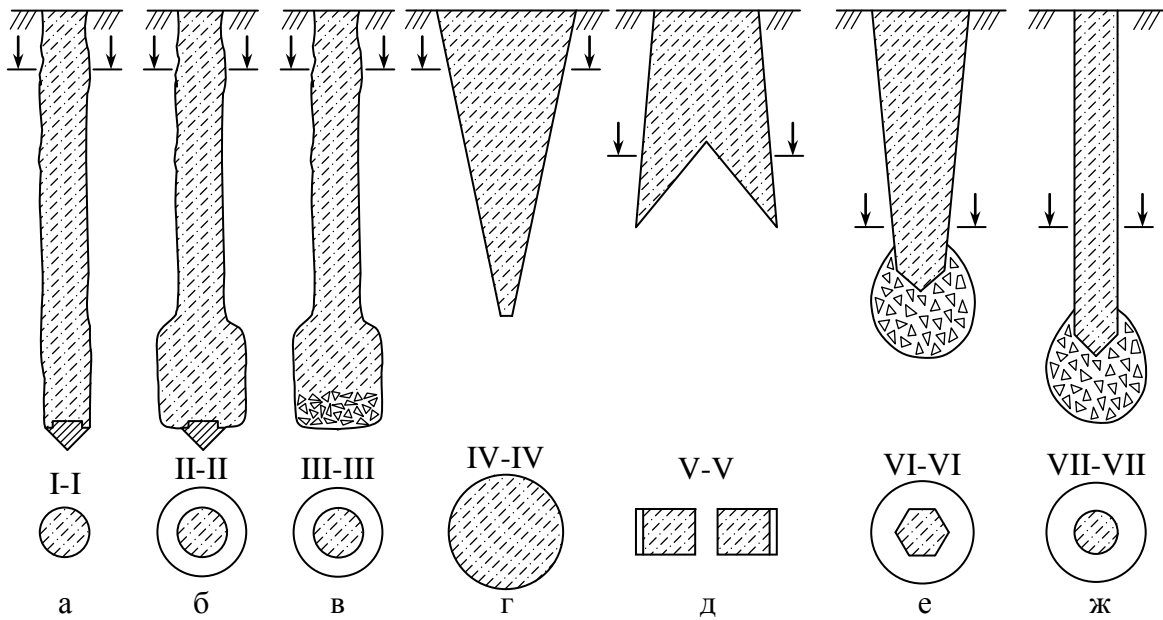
Фундаменти і палі, що зводять у попередньо влаштованих порожнинах:
